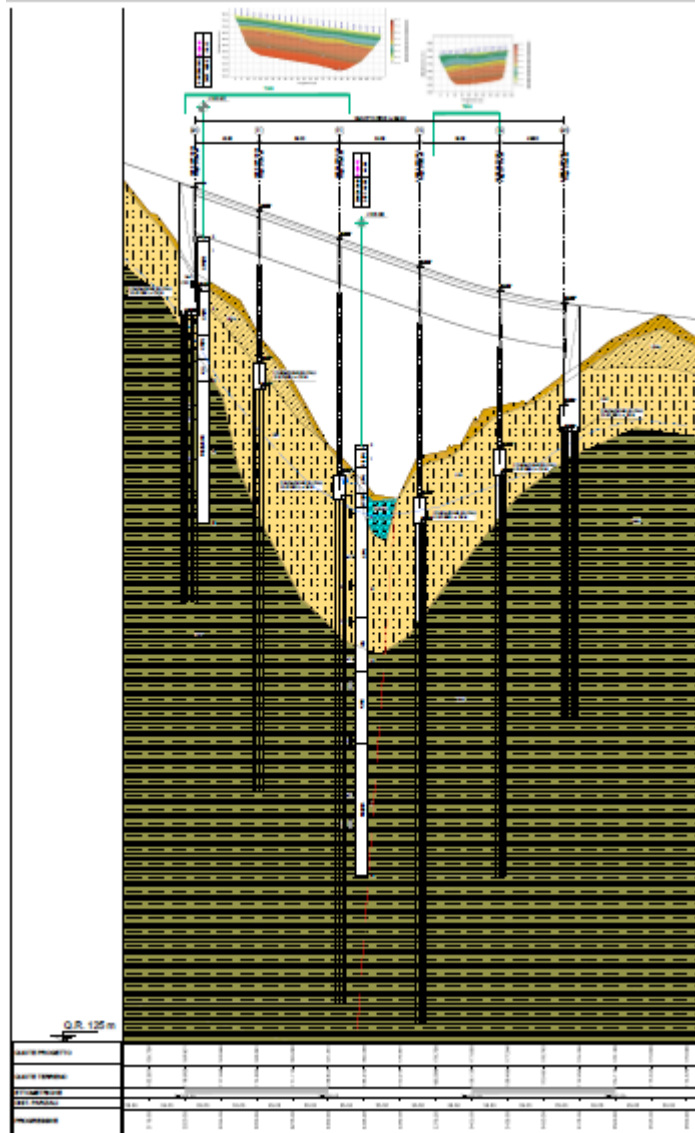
Stralcio del profilo geotecnico del ponte
